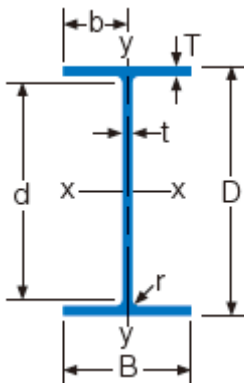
Balok induk elemen frame 612 yang berlokasi di lantai 9 elevasi + 32.50 .
